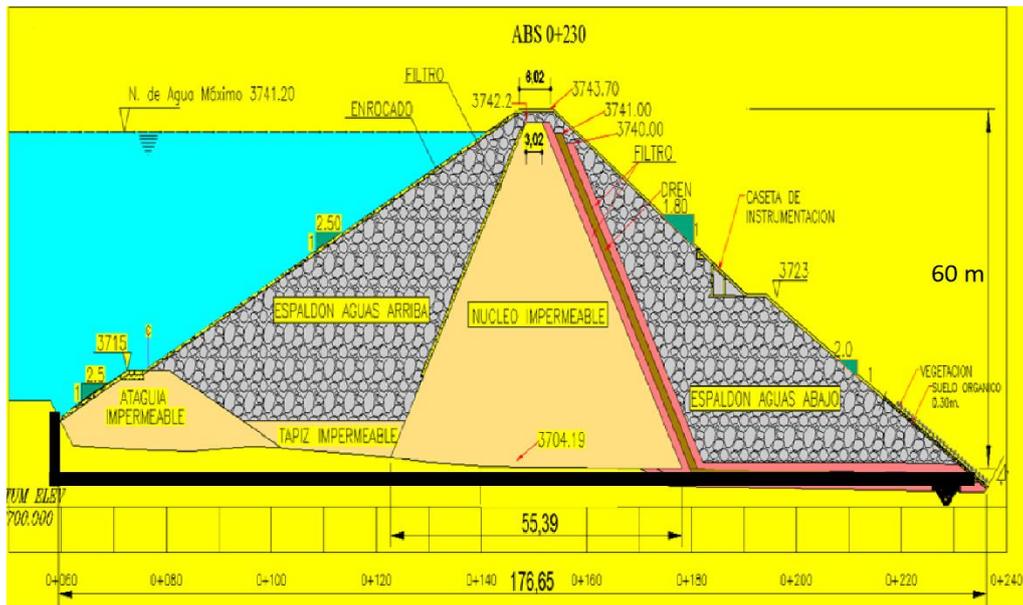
Diseño y dimensionamiento de la represa de Chiquiurcu.
